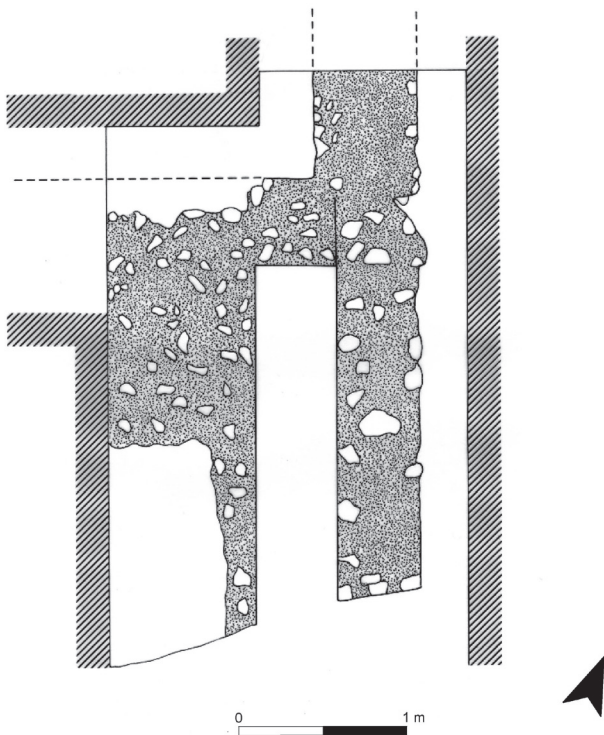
Planta dels murs de l'escala exterior situada a l'extrem sud de l'àmbit C3.
